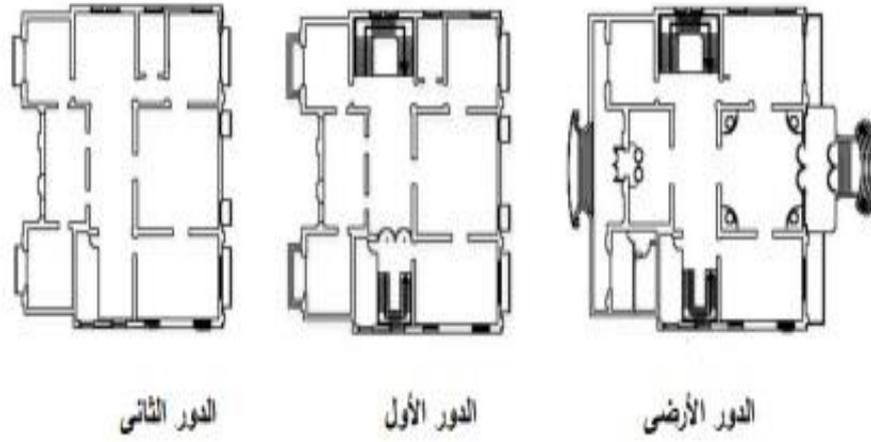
/3) يوضح مكونات متحف محمود خليل مختار وحرمة
